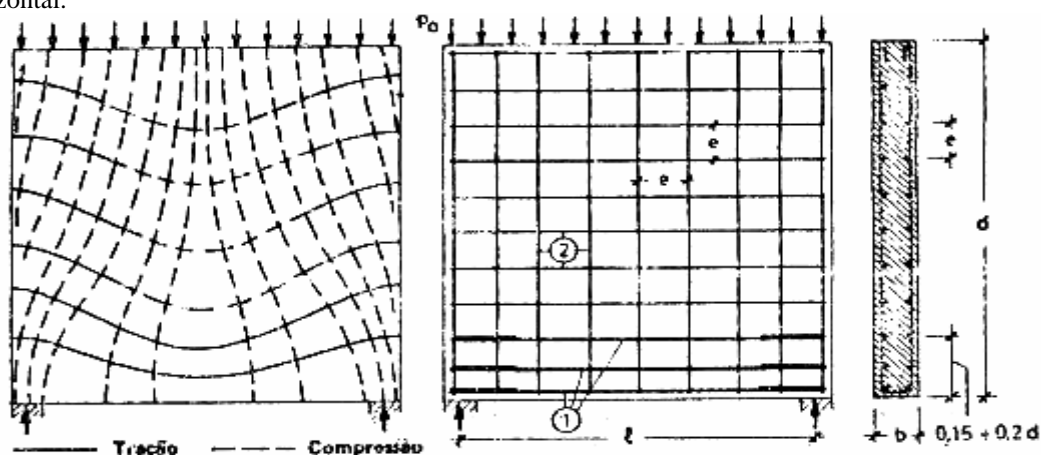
Trajectória de tensões e armaduras em parede simplesmente apoiada.
